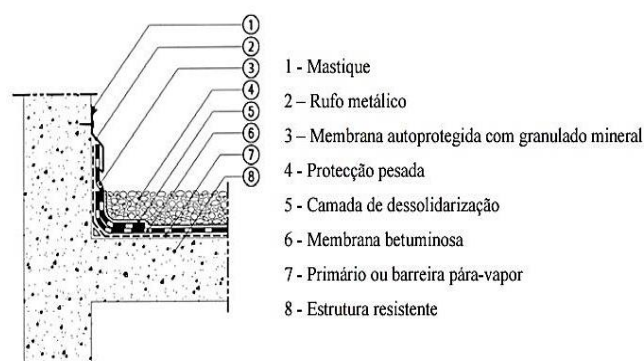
Pormenor de remate protegido com rufo metálico [w29]
